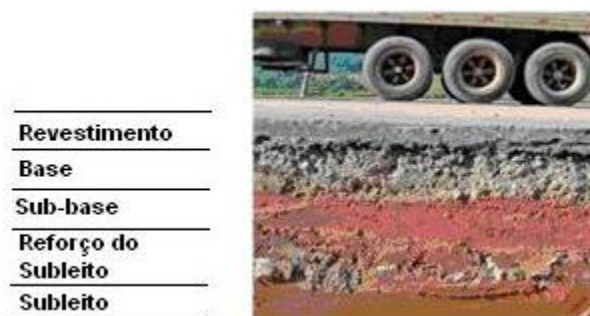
CAMADAS DE UM PAVIMENTO FLEXIVEL - FONTE: (7)
